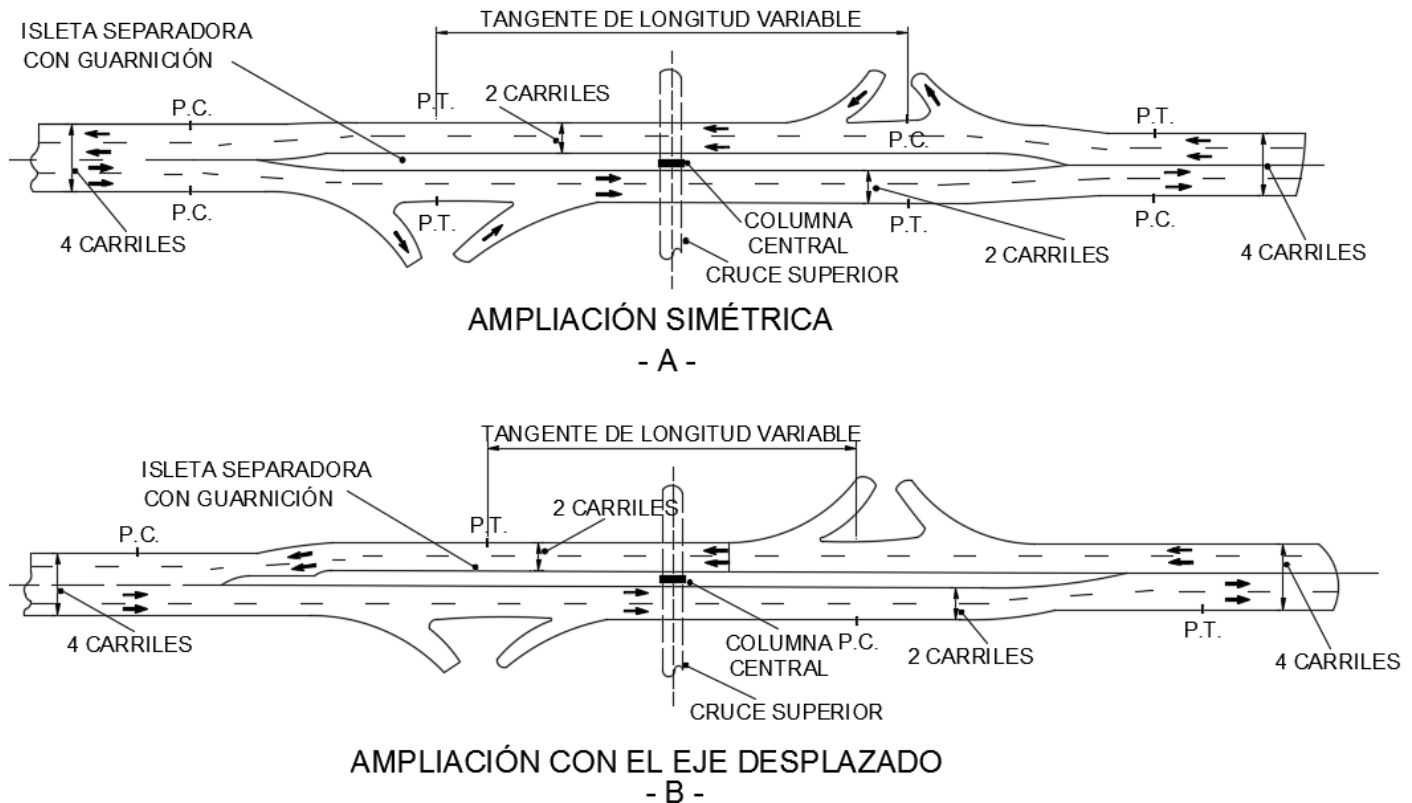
Ampliaciones para alojar isletas separadas de las intersecciones a desnivel
